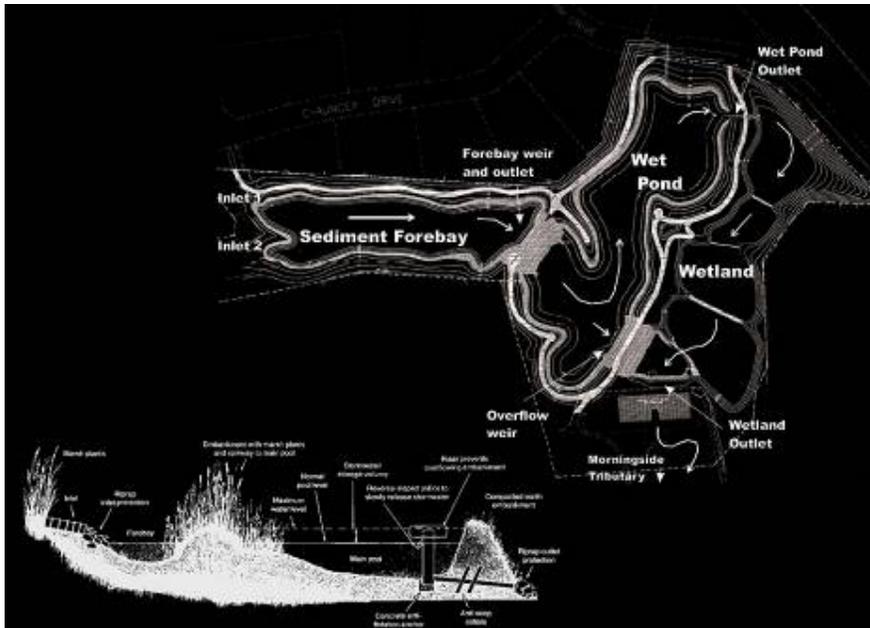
Planta e corte esquemático de uma lagoa pluvial. Fonte: Nathaniel S. Cormier
